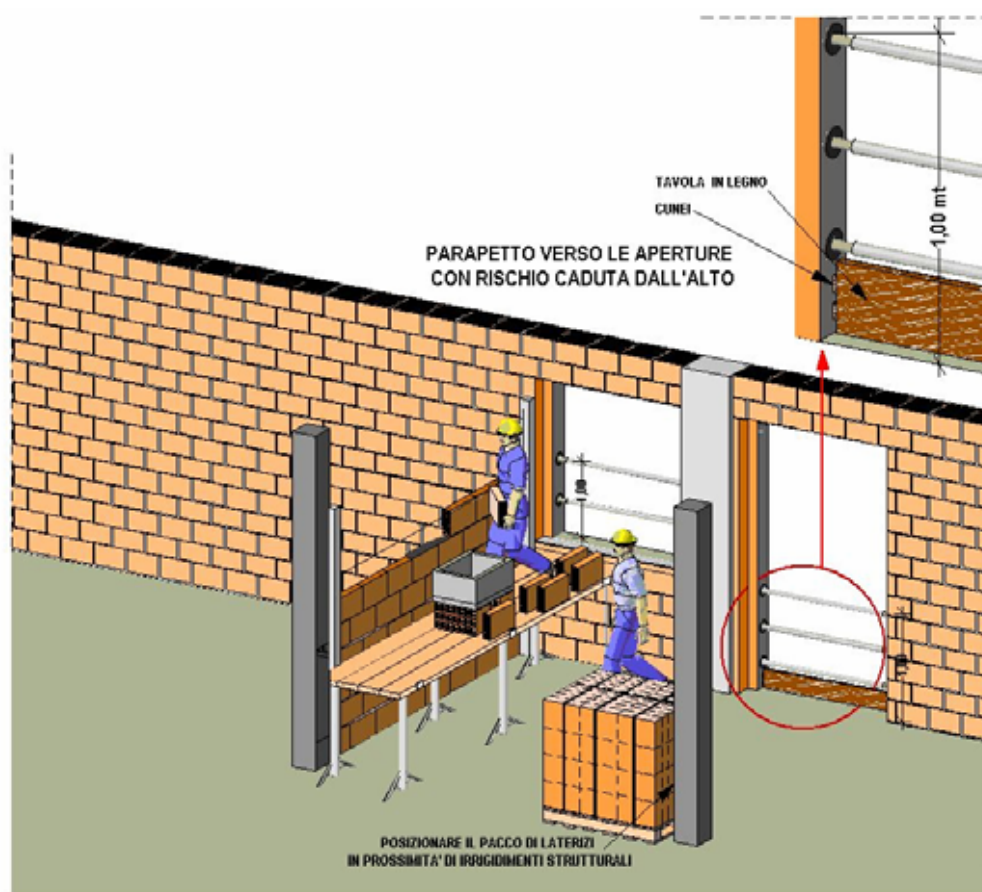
Particolare della costruzione di tramezzi in prossimità di aperture verso l'esterno. Allestimento dei parapetti su finestre e porte finestra nel caso di mancanza de ponteggio esterno
